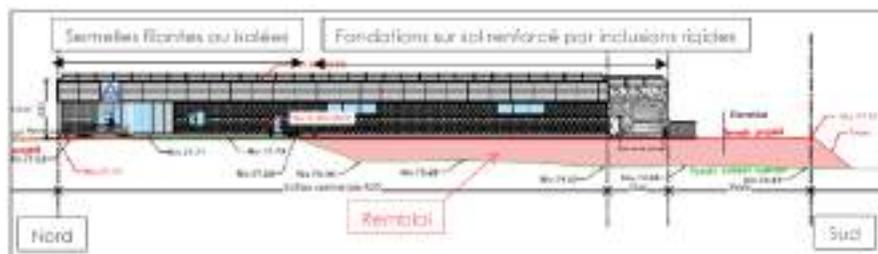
Vue en coupe longitudinale du projet – Source : GEOTEC et IMMALDI
